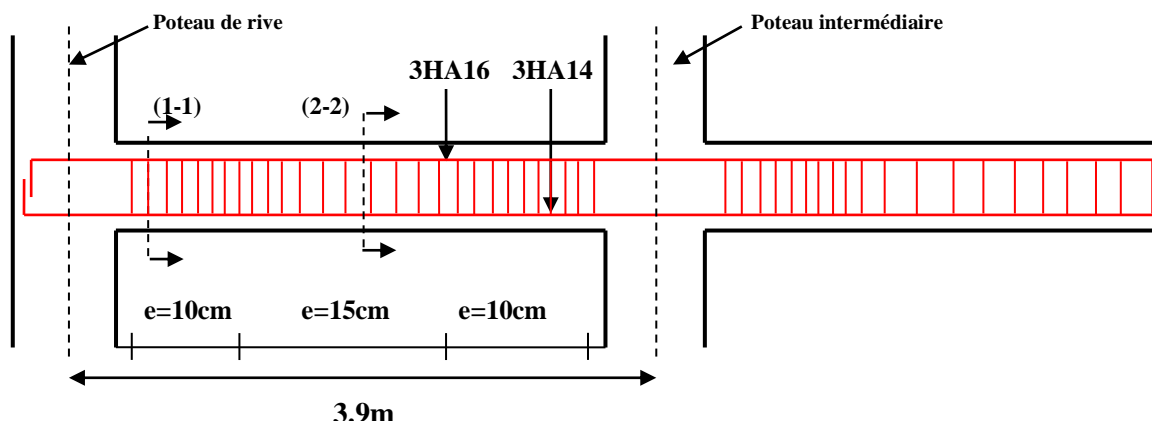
Exemple de dispositions constructives de la poutre principale.
